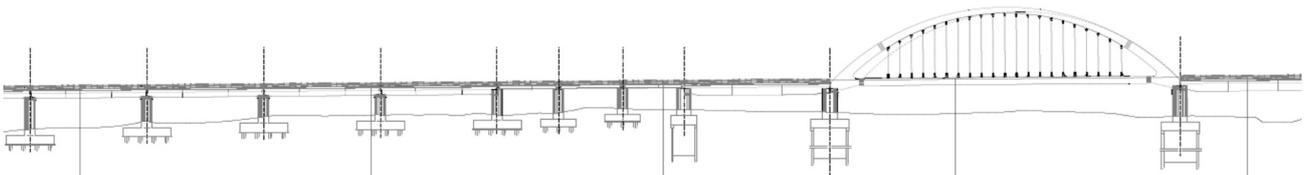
Prospetto parziale del viadotto VI01. Impalcato metallico ad arco di attraversamento dell'autostrada
